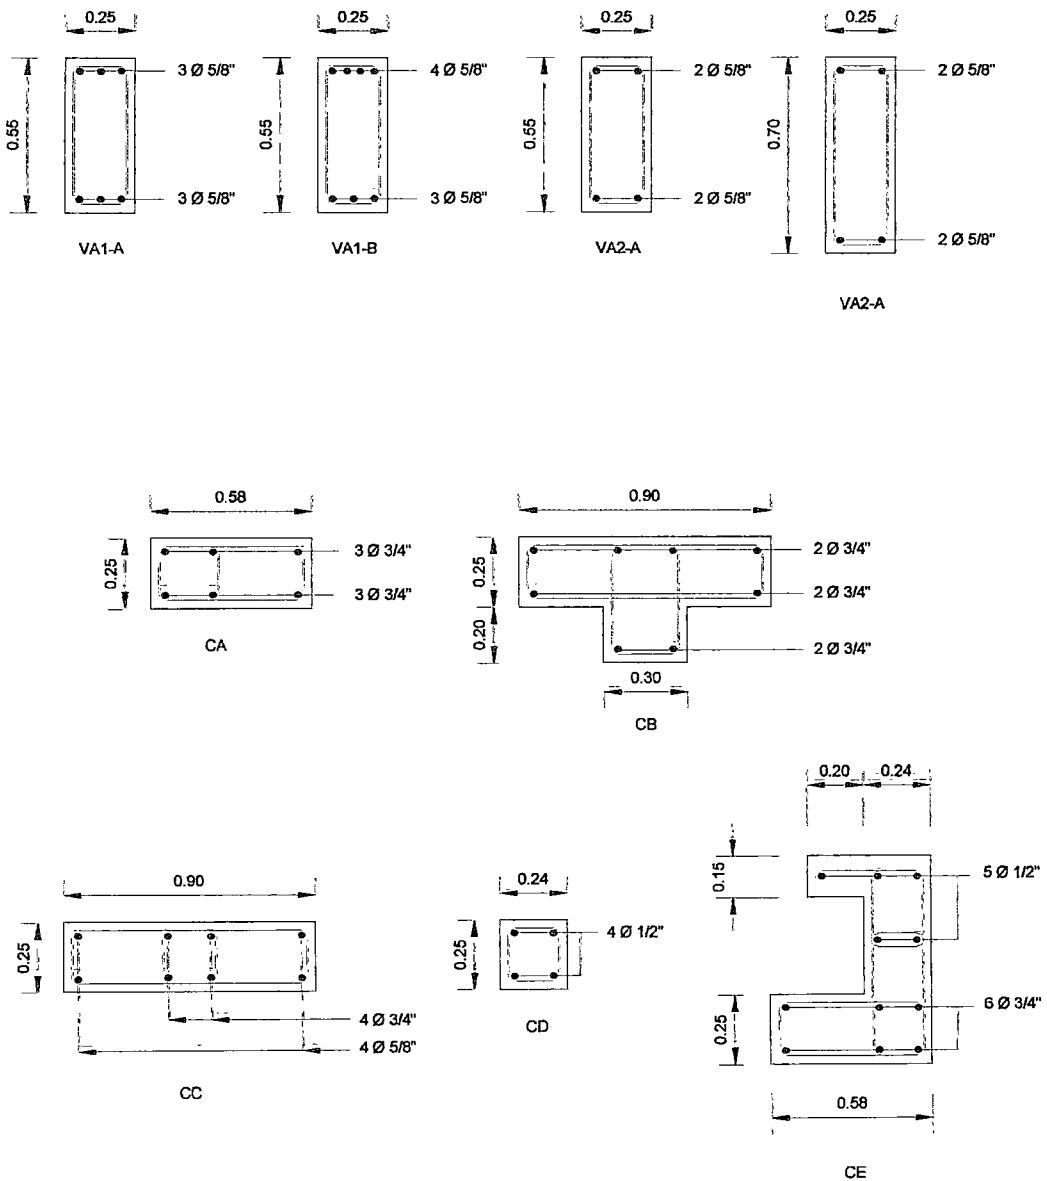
Secciones de vigas y columnas. Módulo 780.
